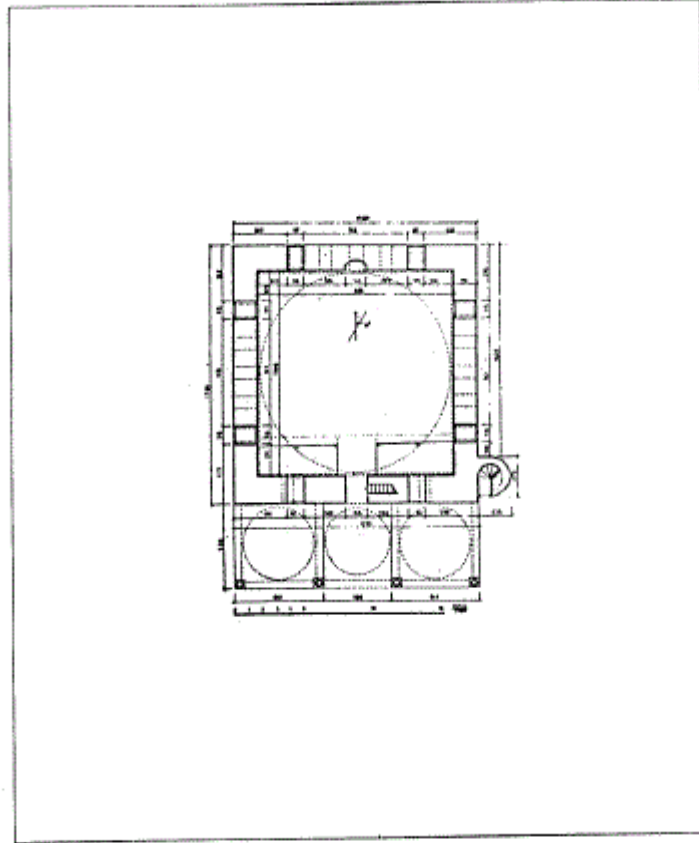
مسقط أفقي لمسجد أحمد بك أورتونوس أوغلو في يانيس فردار (عن : كيل) .
